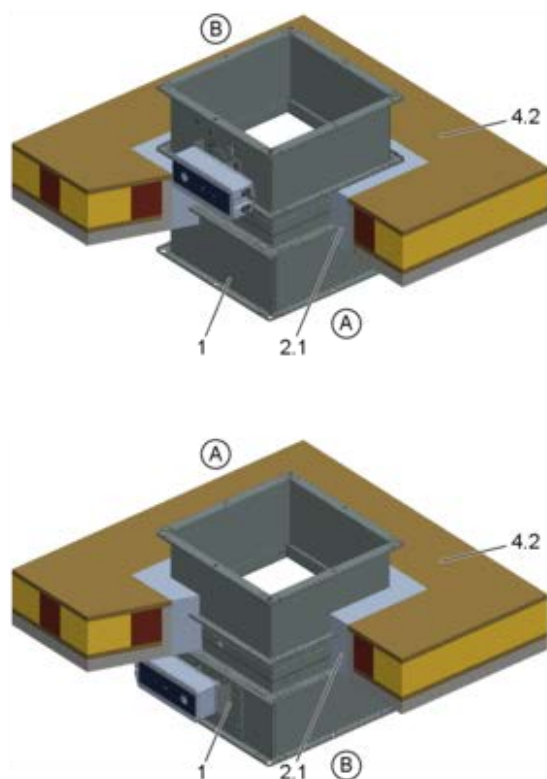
Montagem em argamassa num teto de vigas de madeira/teto de madeira laminada colada, vertical e suspenso (a ilustração é um exemplo; outras estruturas de teto podem ser possíveis mediante pedido)
